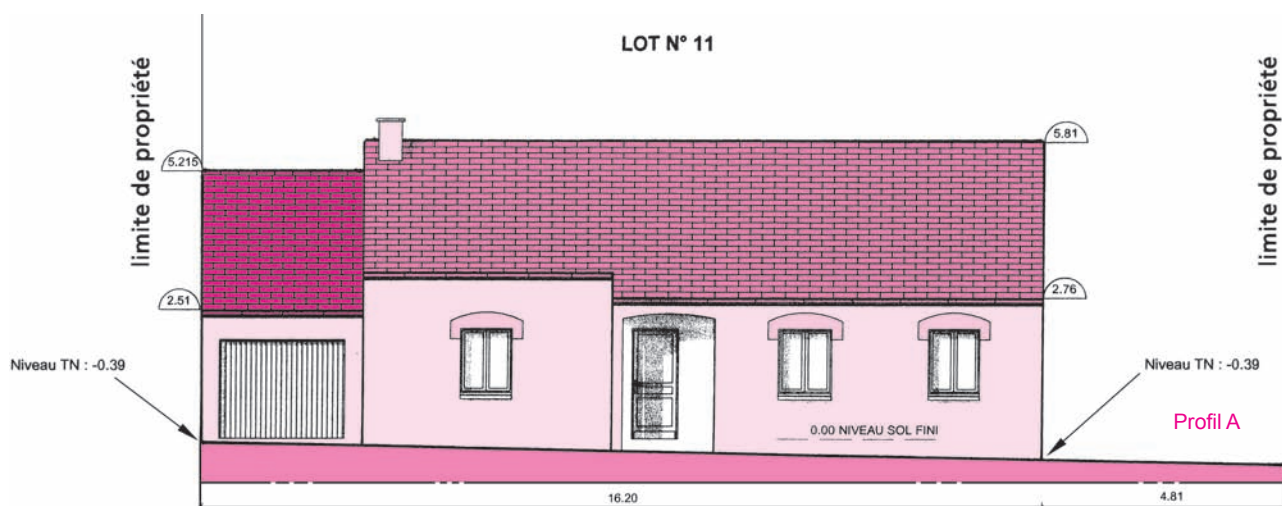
Coupe de la maison sur le terrain avec présentation de la façade
